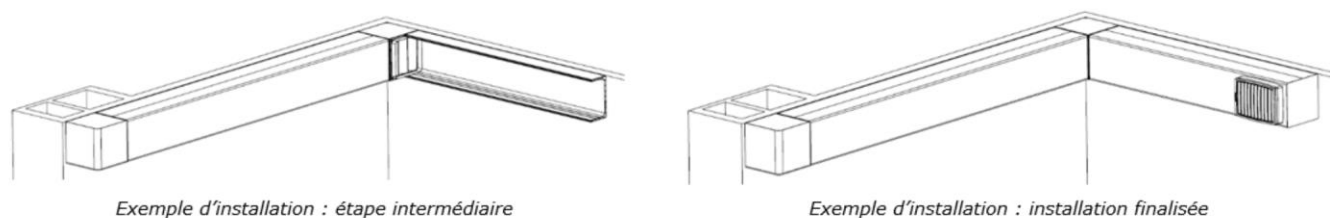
Exemples de mise en œuvre des conduits horizontaux JOK'AIR
